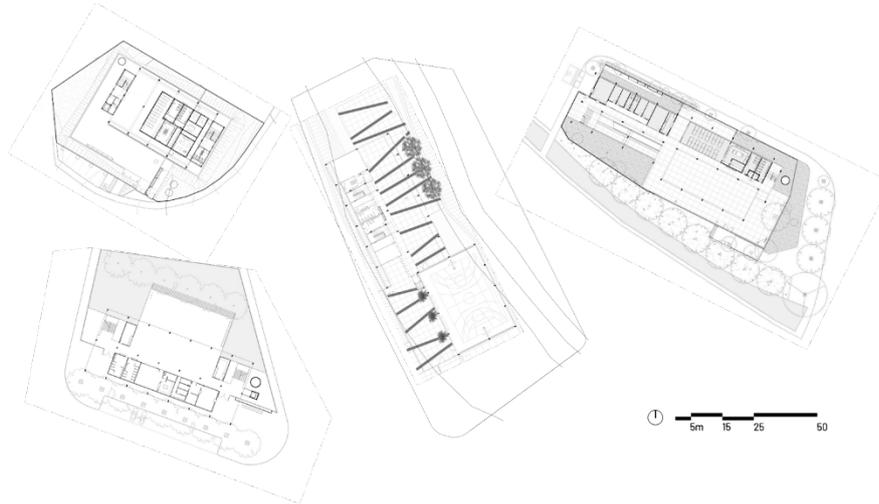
Planta do pavimento térreo das escolas de São Paulo na mesma escala.
